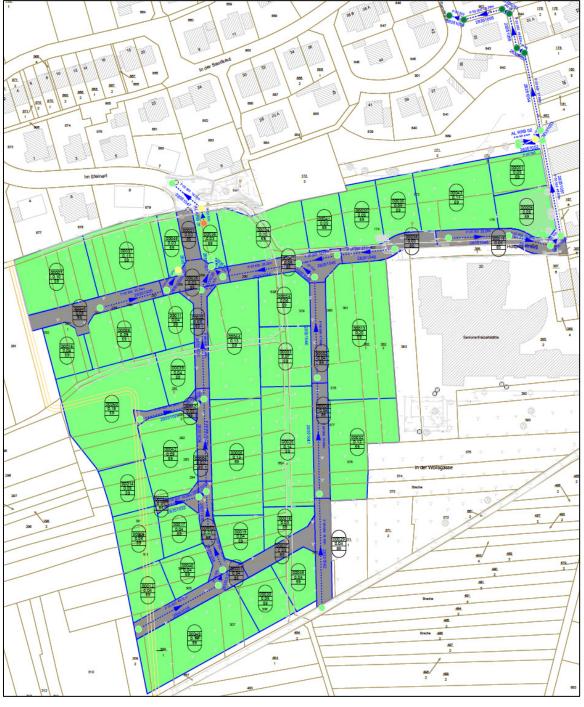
Lageplan Einzugsgebiete der RW-Kanal-Leitungen
